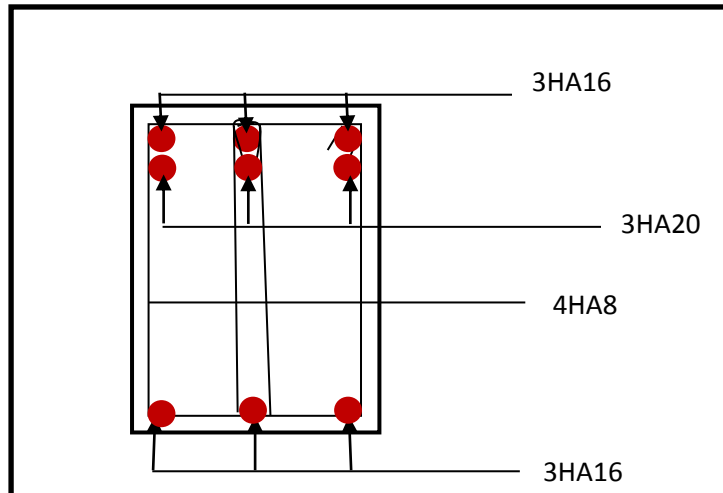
Ferrailage sur appuis d'une poutre principale.
